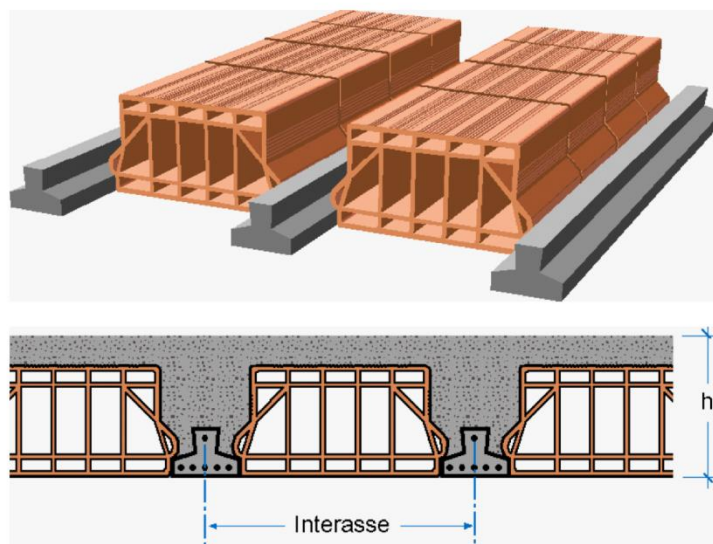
Esempio di solaio in cemento armato a travetti in cemento armato e blocchi interposti
